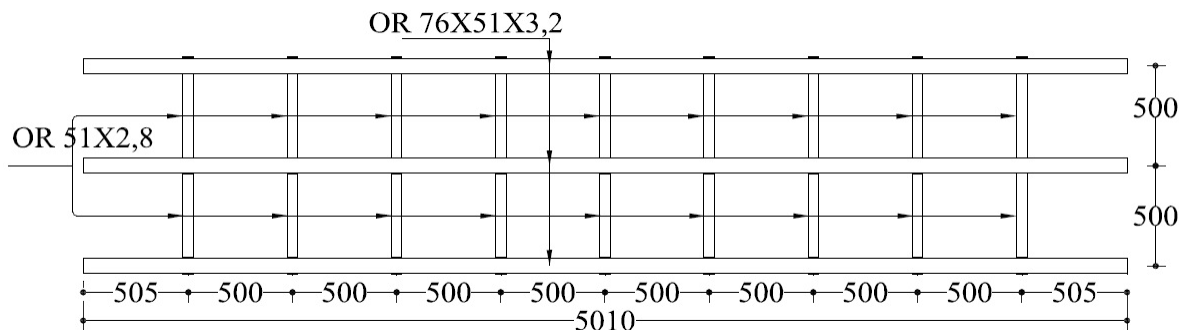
Planta Malla Metálica (Sin escala, Unidades: mm)
